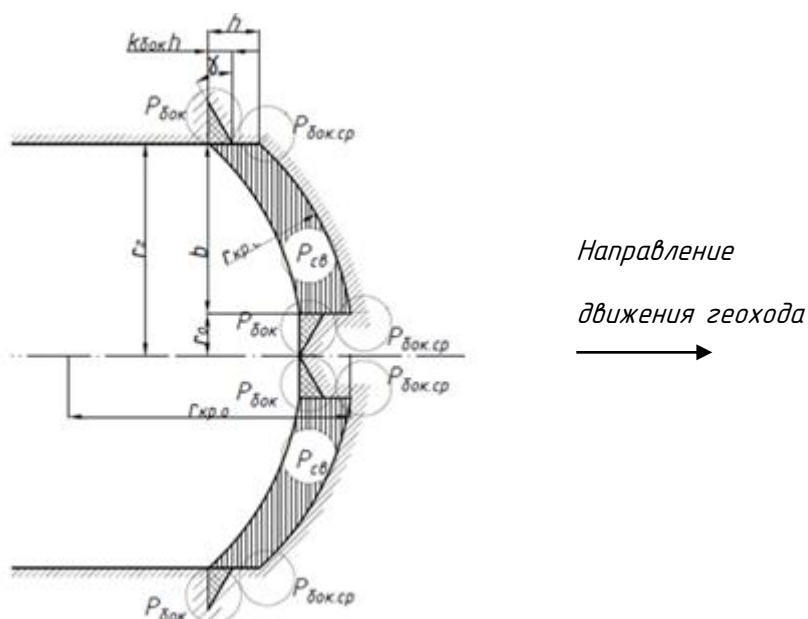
Схема действия сил резания ножевым ИО геохода с полувыпуклой формой режущей кромки ножа
